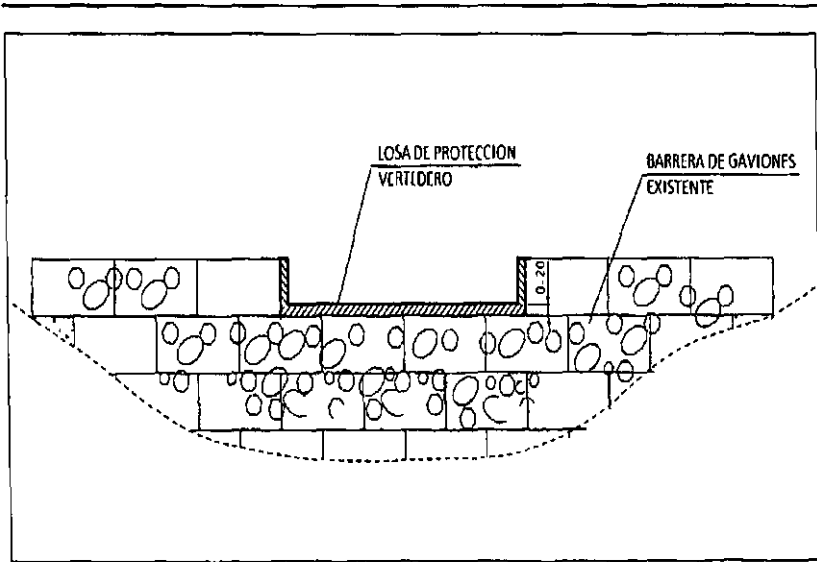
Losa de protección de vertederos de barreras de gaviones
